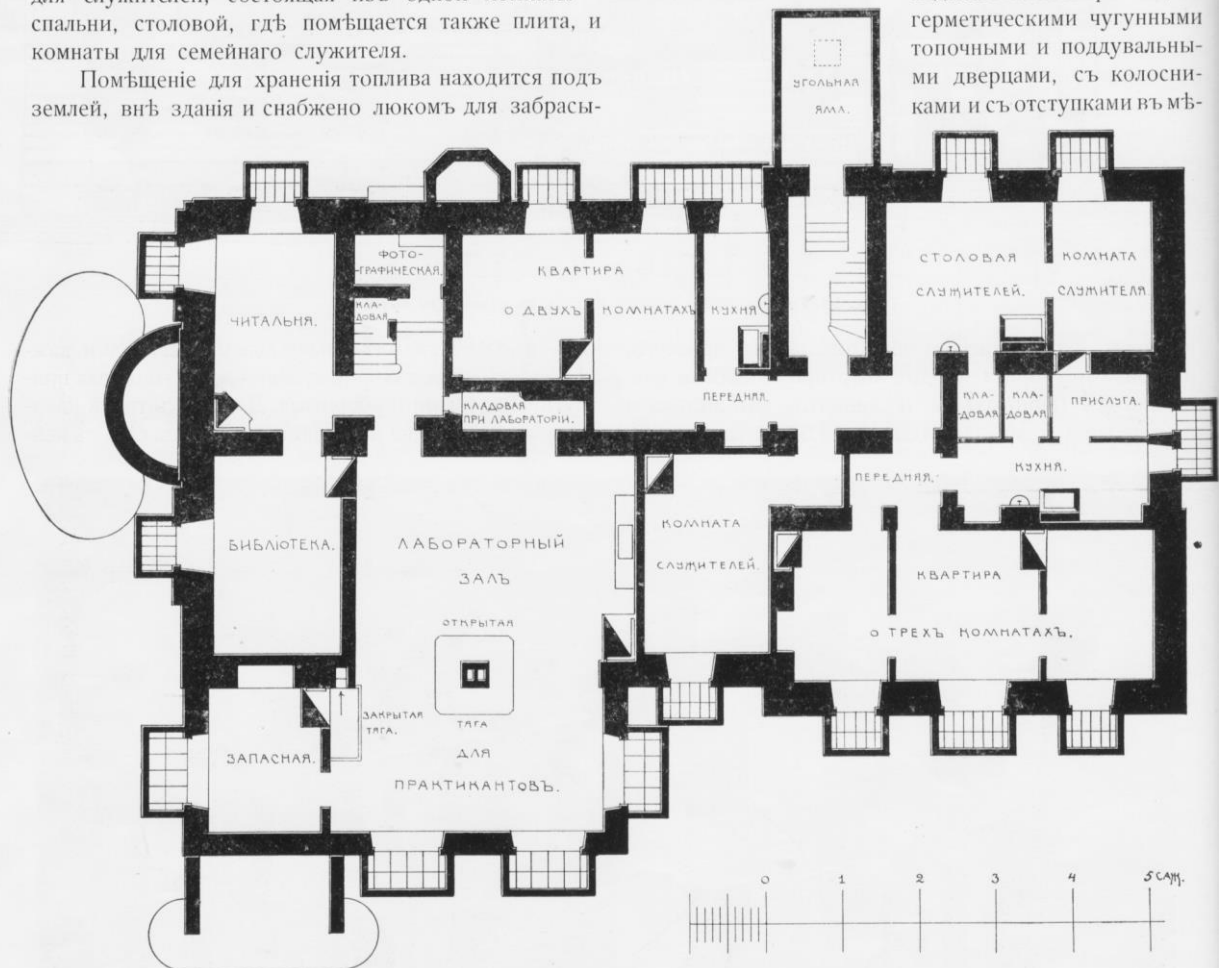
Главное здание Станціи. Планъ нижняго этажа (съ натуры).
